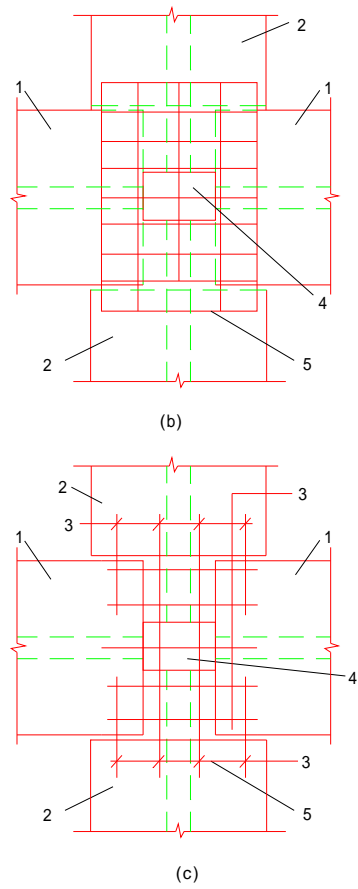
楼板上层钢筋焊接网与柱的连接(二)
